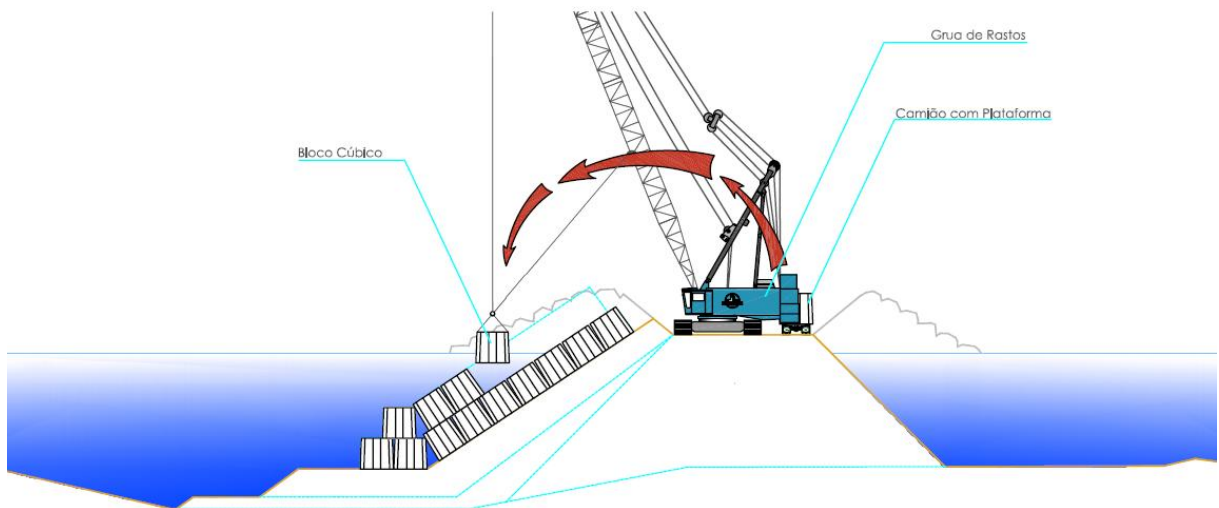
Construção do manto resistente, colocação de blocos Antifer por meios terrestres, esquema em corte longitudinal 1. (ETERMAR – Engenharia e construção S.A.)
